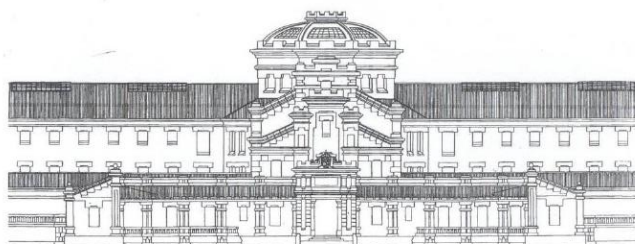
Detalle planta y alzados. Fuente: Arquitecturas de la provincia de A Coruña. José Ramón Soraluze Blond. Xosé Fernández Fernández. Diputación de A Coruña
